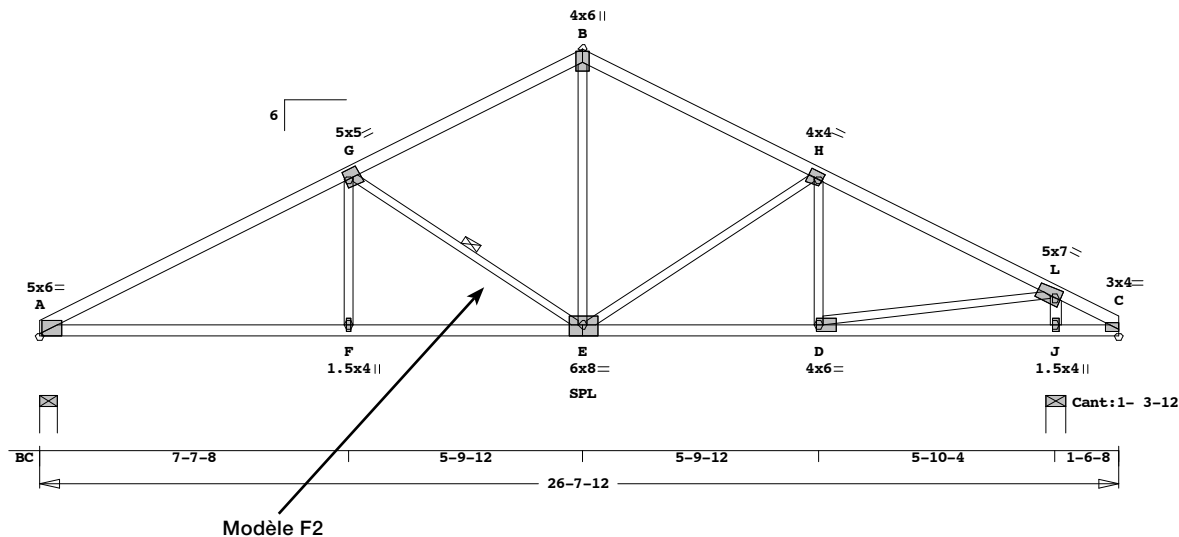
• Exemple de profil extérieur de ferme de toit (MiTek Canada)
